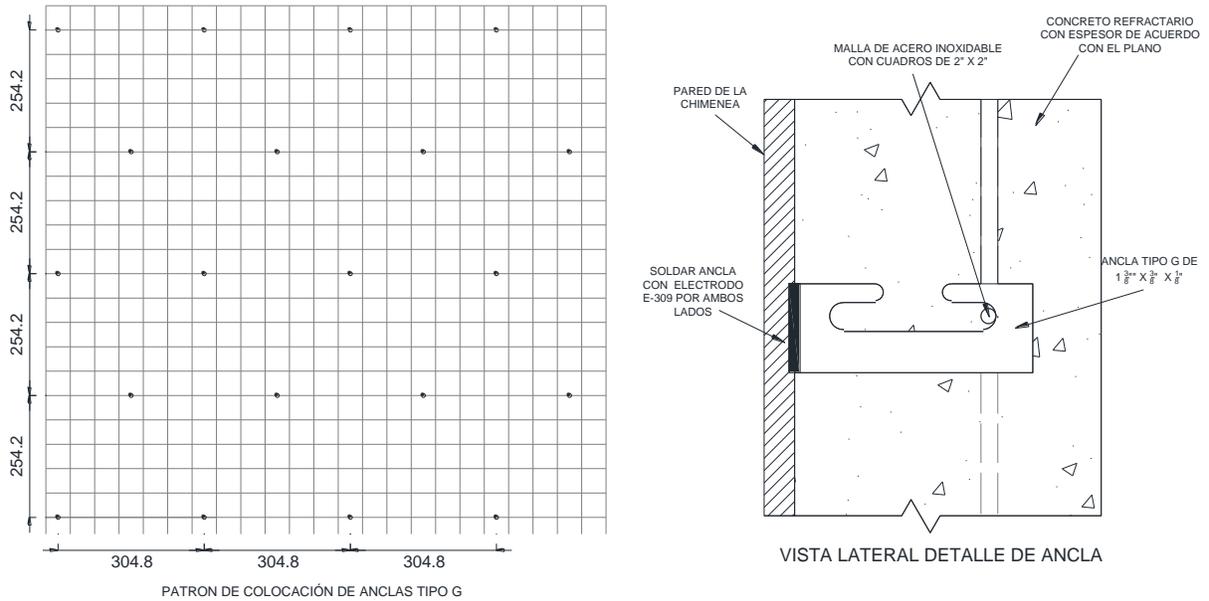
Distribución de anclas tipo "G" en chimenea. Fuente: Planos del proyecto.
